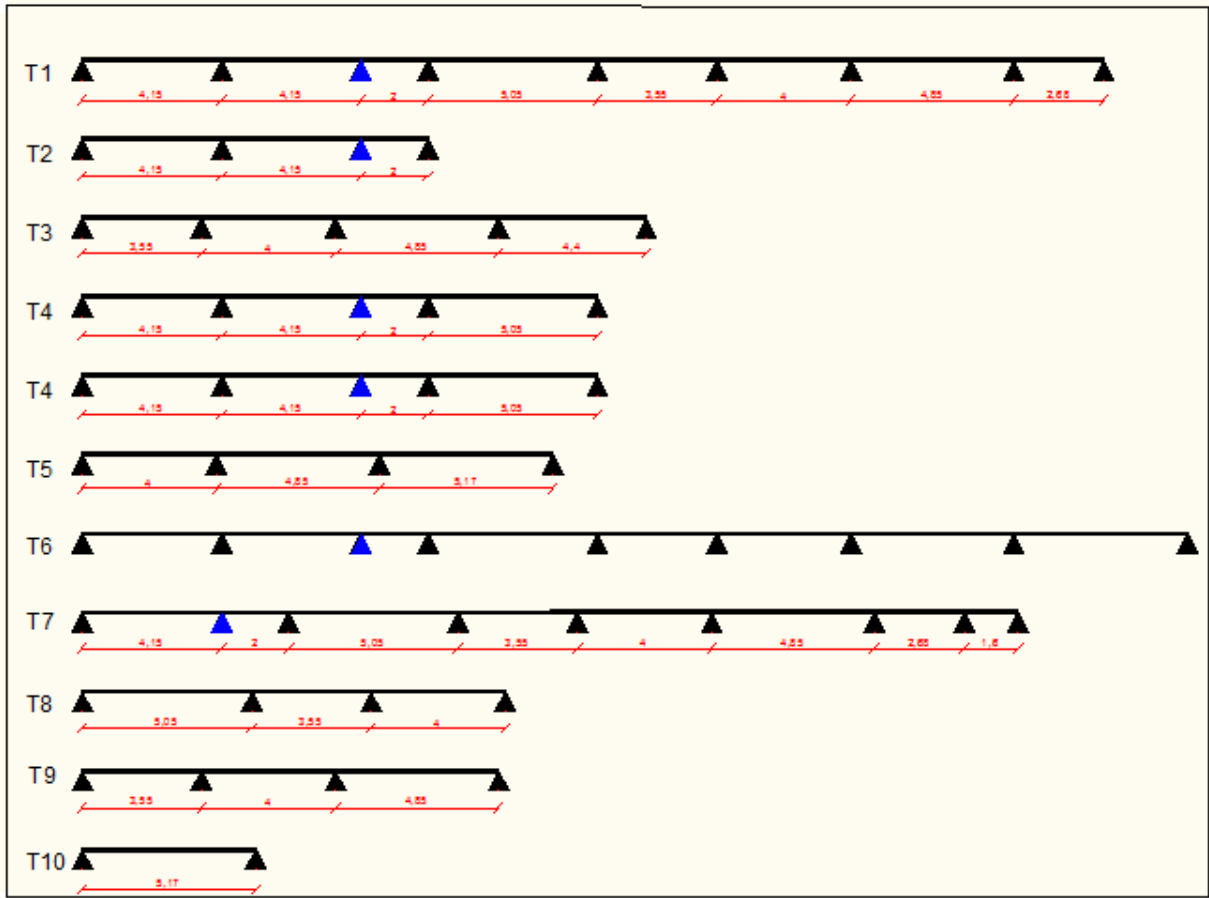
schéma statique des poutrelles de RDC jusqu'au 2^{ème} niveau duplexe.
